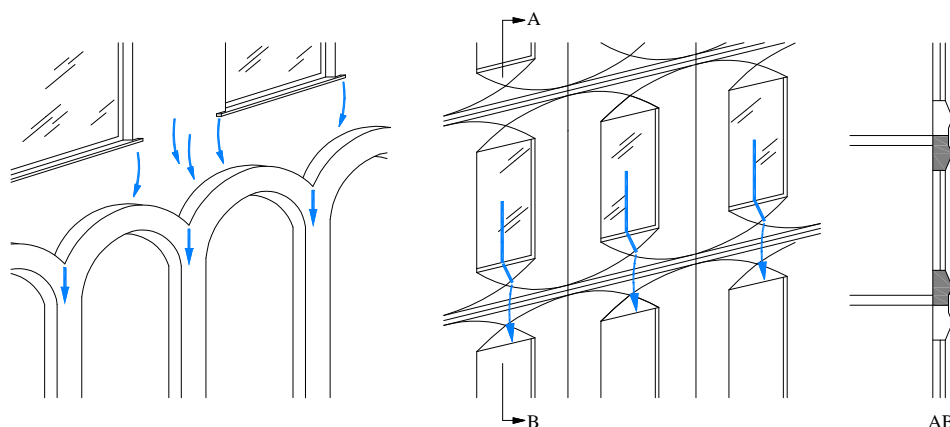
Concentração e canalização de fluxo plano (ROBINSON; BAKER, 1975 apud PETRUCCI, 2000)
